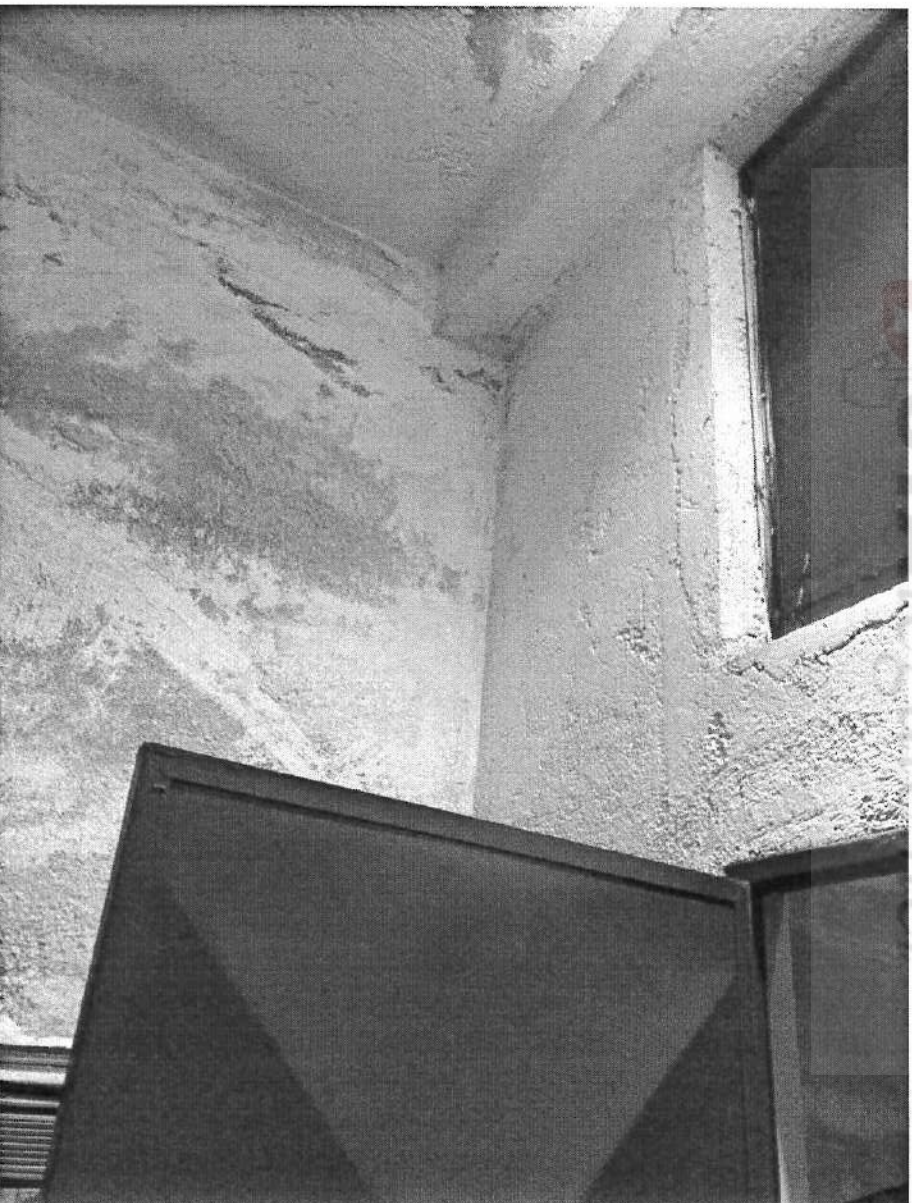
particolare porta di ingresso e sovrastante apertura, vista dall'interno del fondaco
